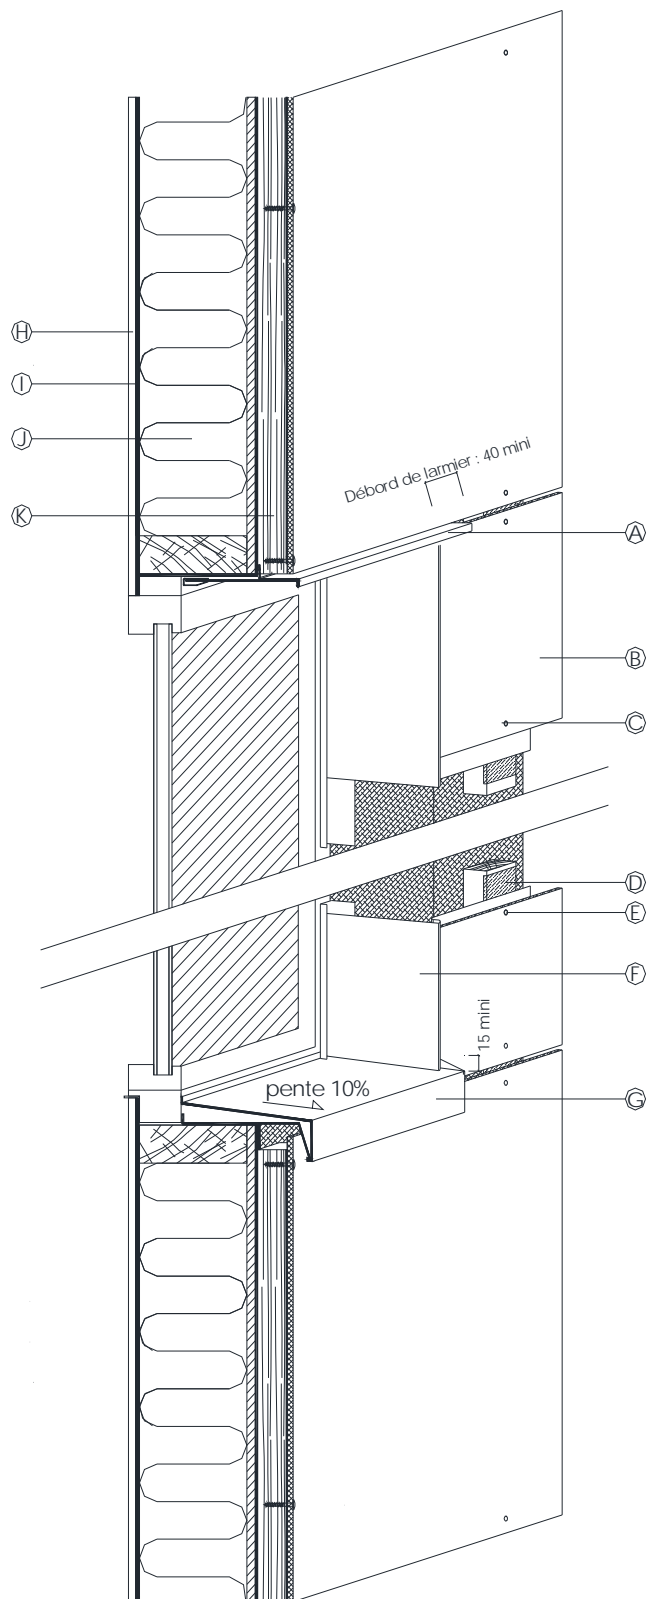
Pose sur COB – Coupe sur tableau de baie
